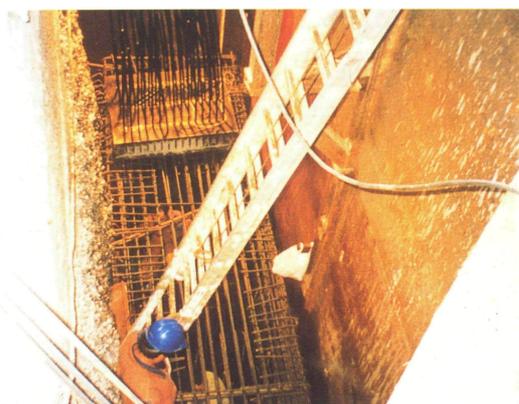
Vista superior de los dados del refuerzo, con la armadura pasiva parcialmente colocada, con las placas de reparto del postesado y con la armadura activa totalmente enfilada y colocada.
